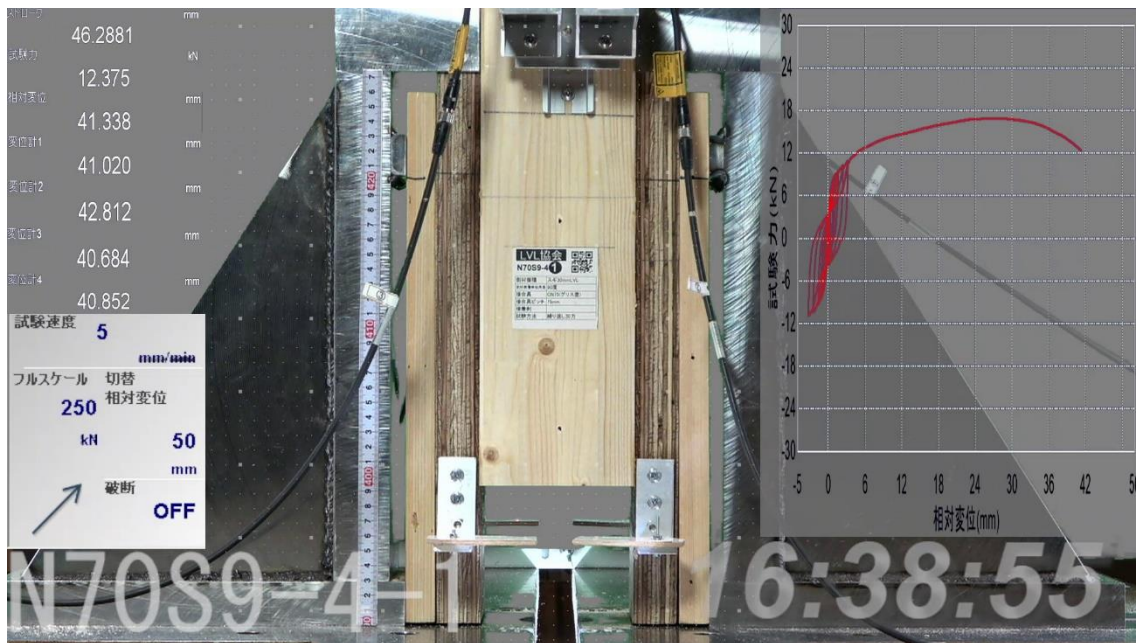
試験中の状況，および破壊状況 (N70S9-4-1)
